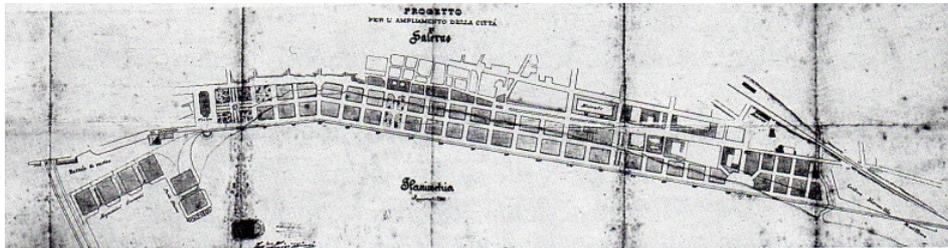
Progetto per l'ampliamento della città, planimetria scala 1:200, ing. DINI, 1887
